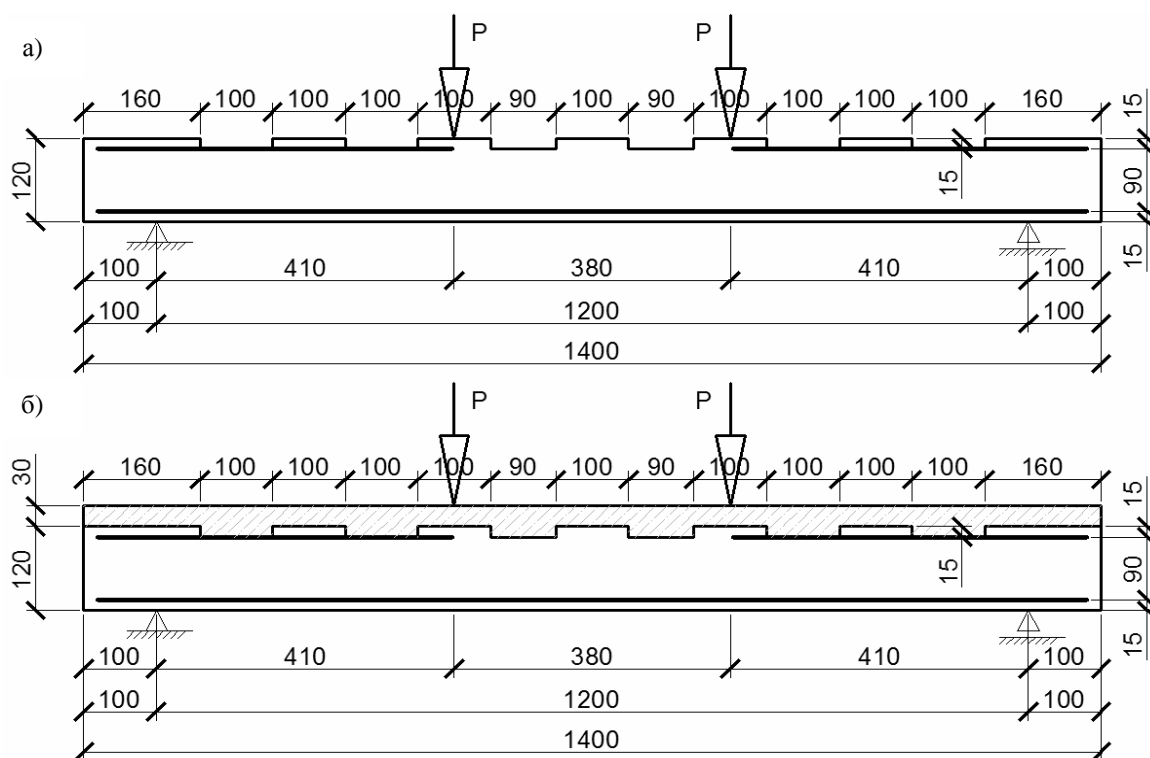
Схема нагружения опытной балки первой серии: а – базовой балки без усиления; б – балки, усиленной наращиванием сжатой зоны
